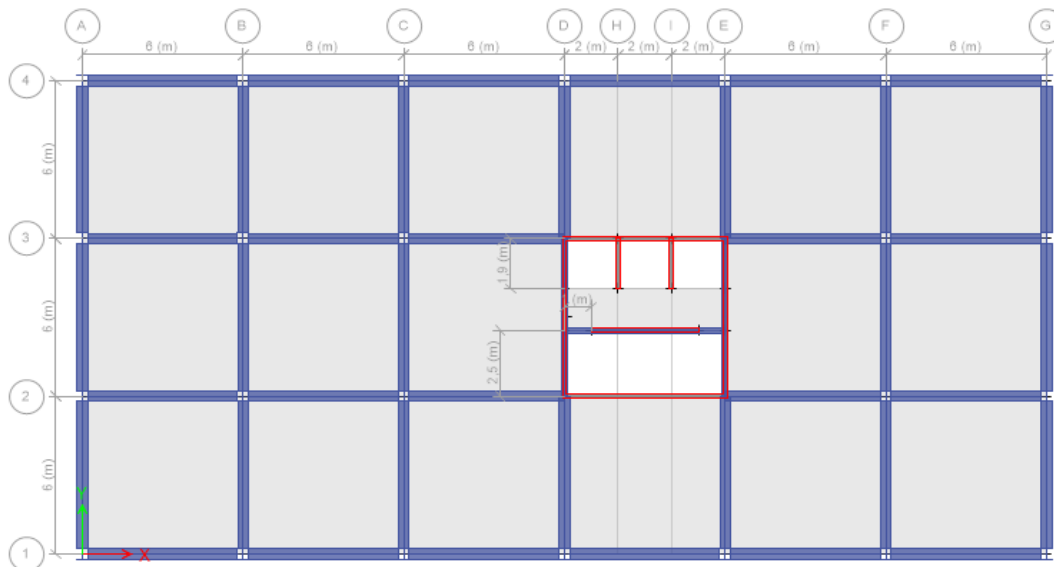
4: Planta estructural característica para todos los modelos en estudio.
